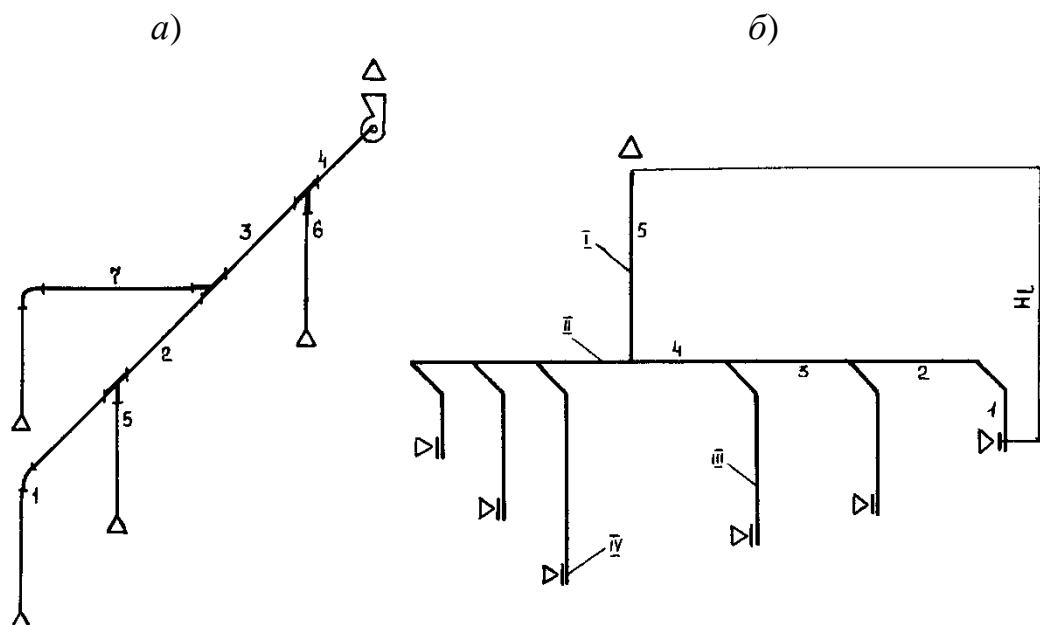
Схемы сетей вентиляции с разбивкой на сети на расчетные участки:
